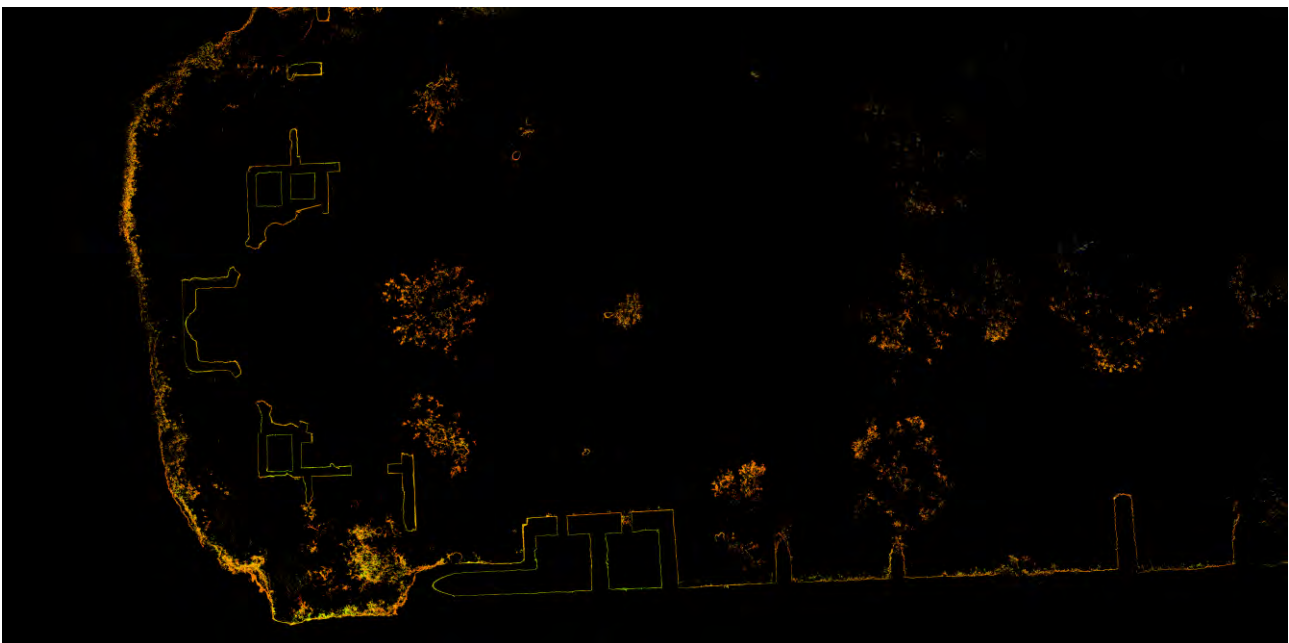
Planimetría en elevación ~ 2 [m] obtenida tras la eliminación del "ruido". Aunque más comprensible para una lectura arquitectónica, los árboles siguen estando presentes en el sitio estudiado. (Fuente: Autor).
